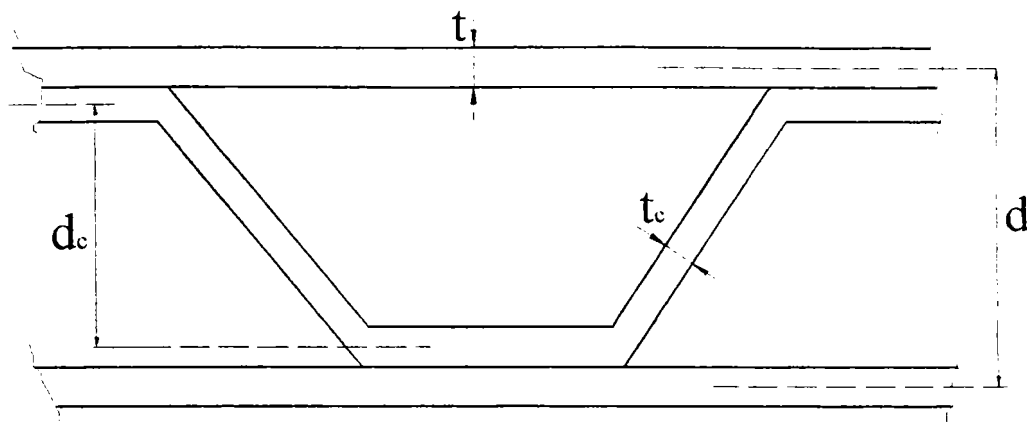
Dimensiunile panoului cu miezul din tablă cutată
